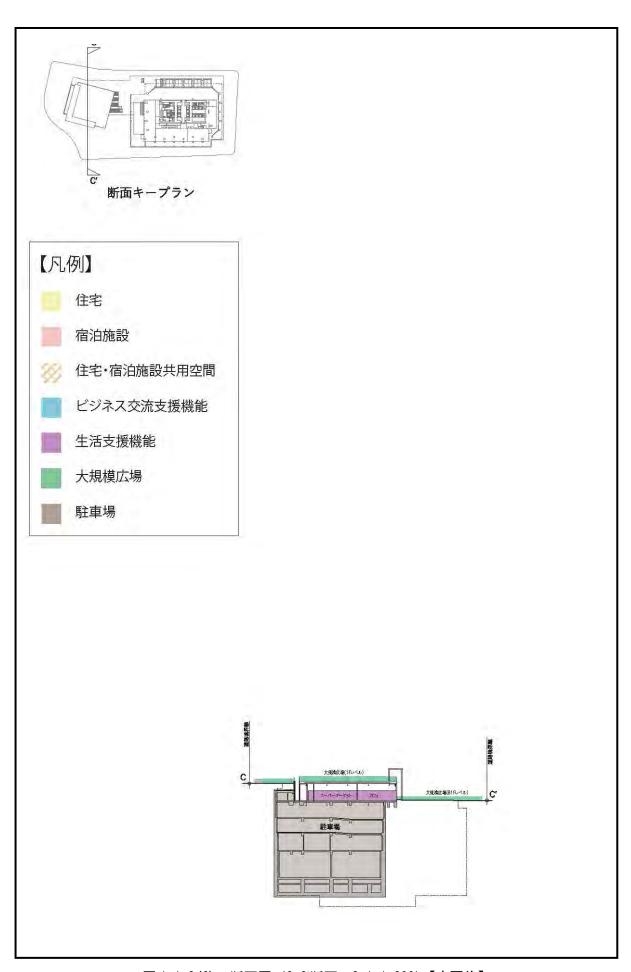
(6) 断面図 (C-C'断面 S=1:1, 200) 【変更後】
